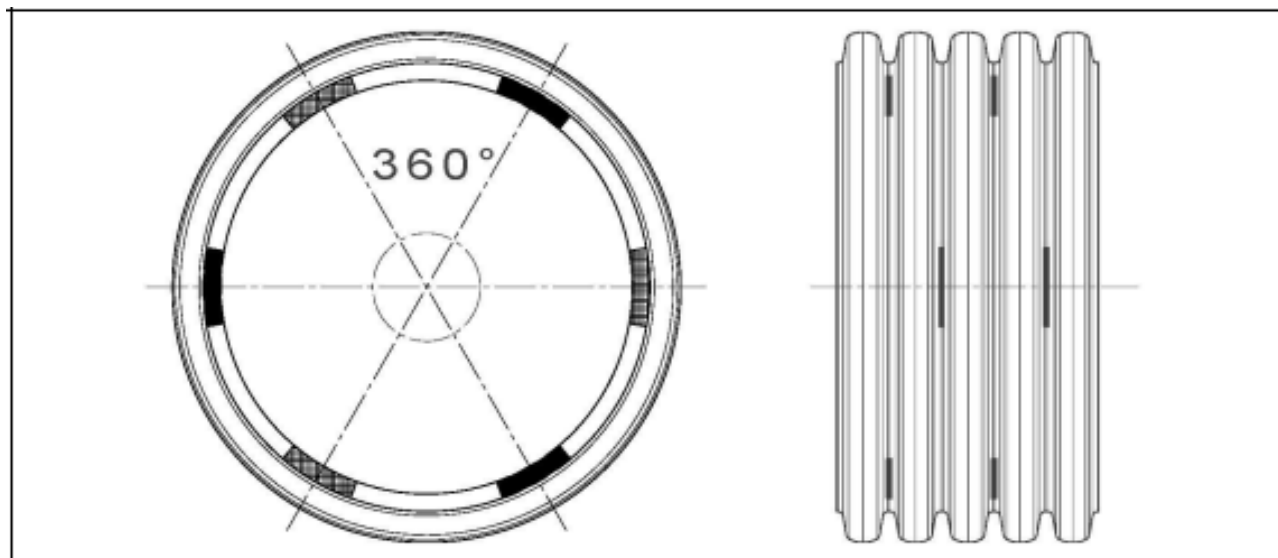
Prospetto e sezione tipo di un dreno elementare fessurato.
